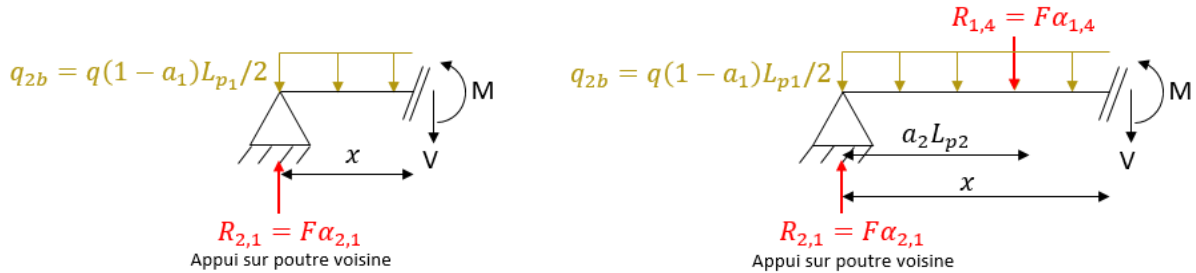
Poutre type 2 – coupe 1 (gauche) et coupe 2 (droite)
